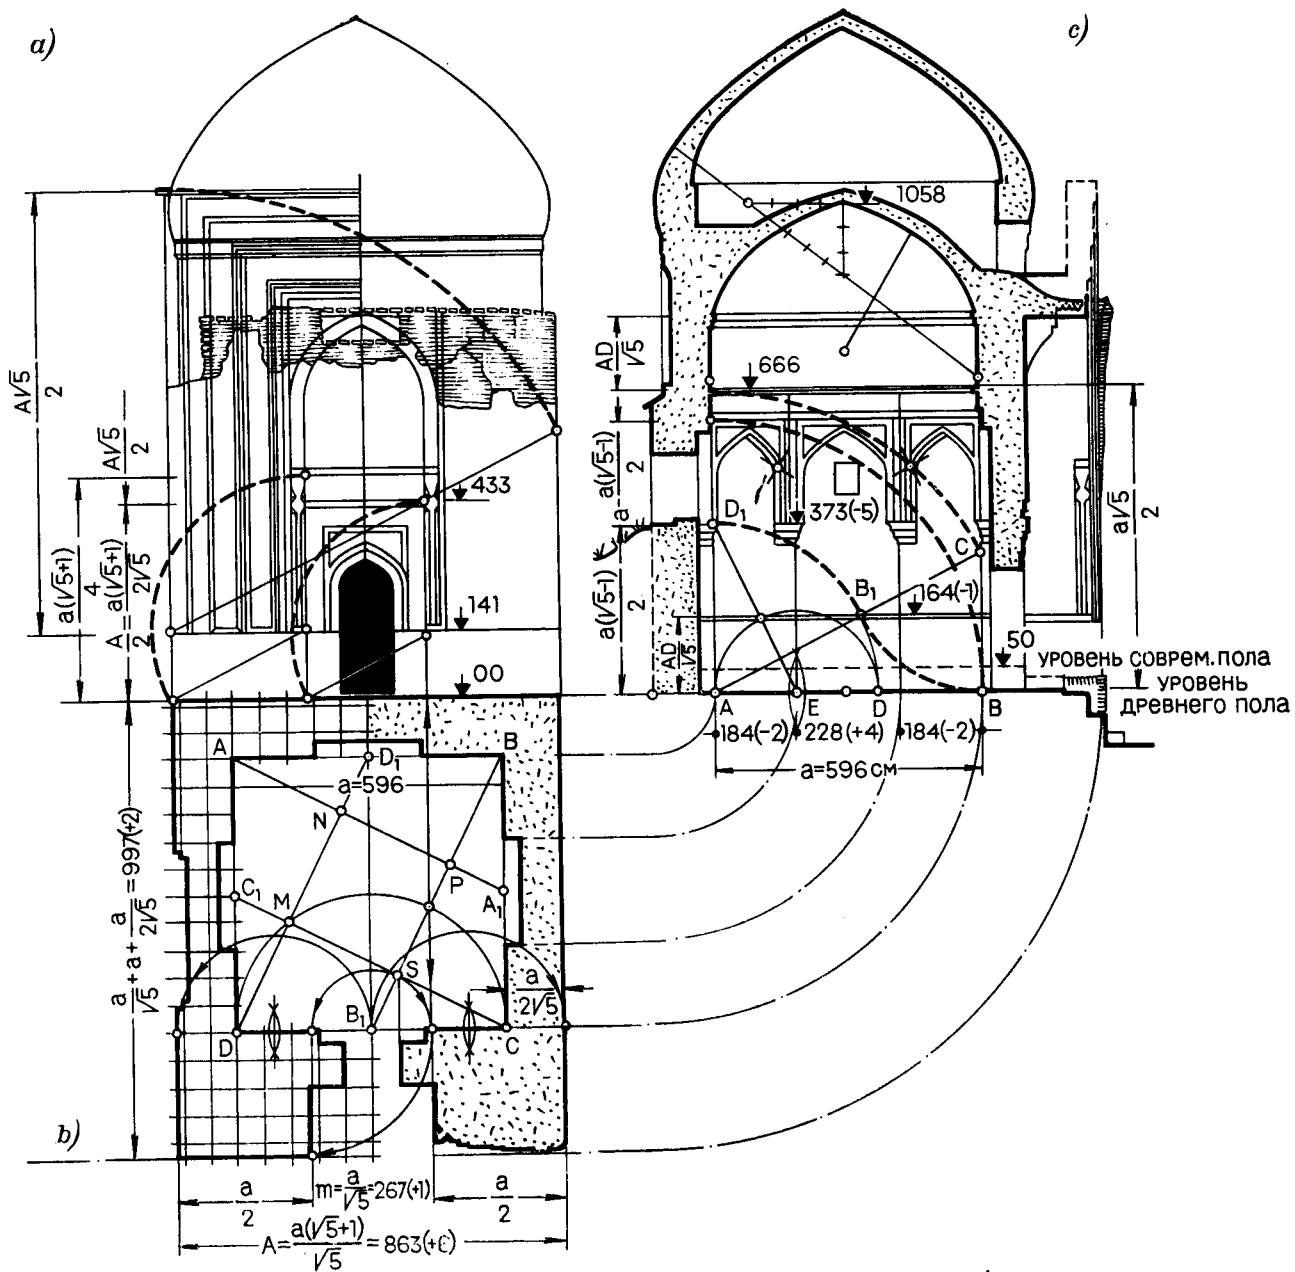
Мавзолей Ширин-бека-ака в Шах-и-зинда (1385 г.). План, фасад и разрез.
